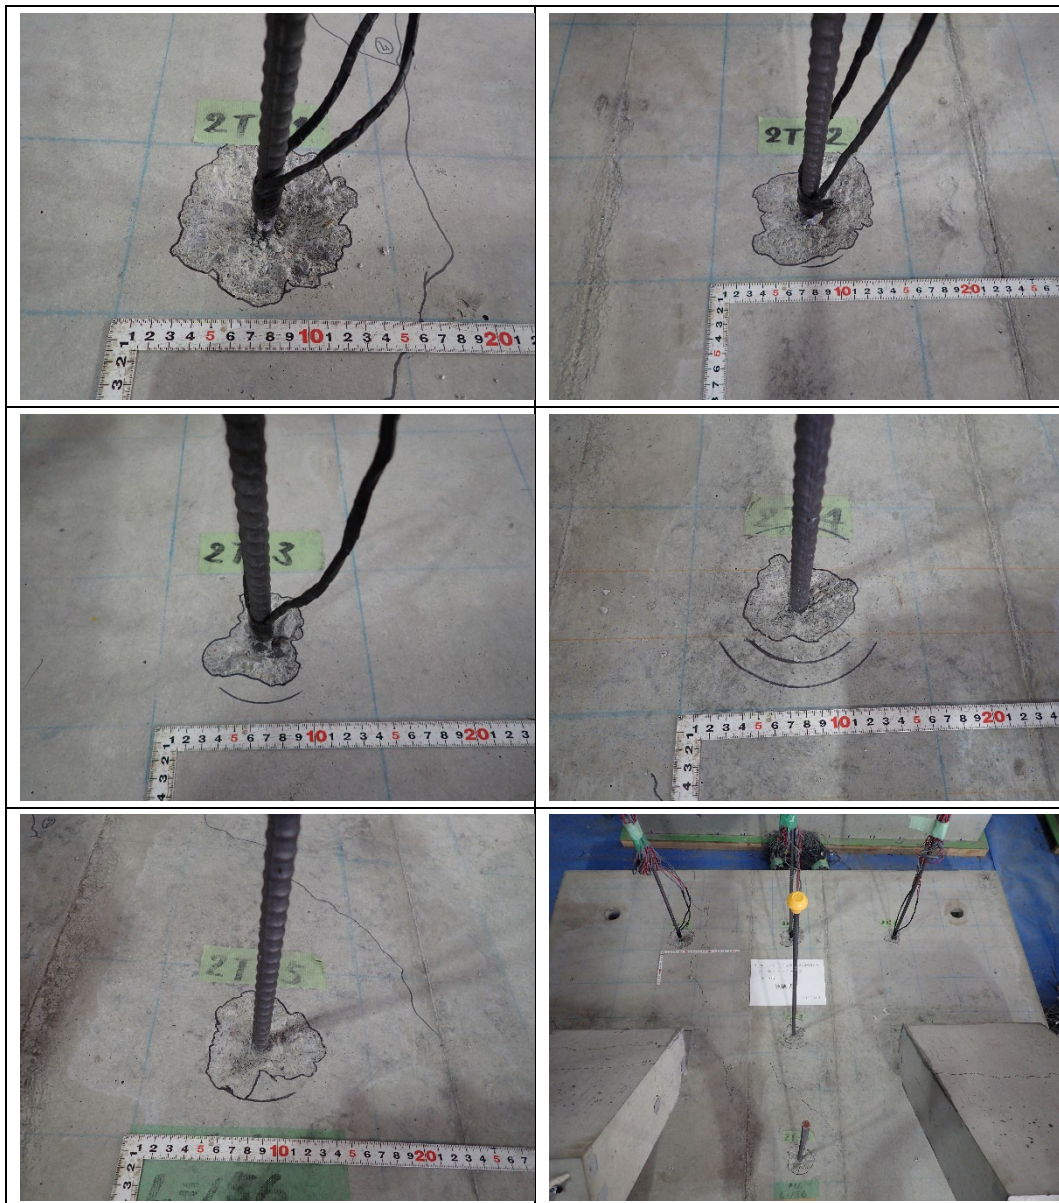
あと施工アンカー単体実験破壊状況 (2T-1～2T-5)
